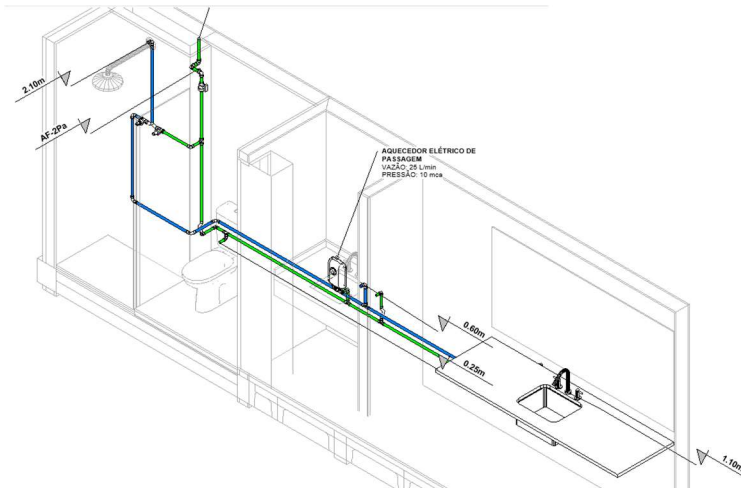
1º Pavimento – Isométrico do apartamento J.
